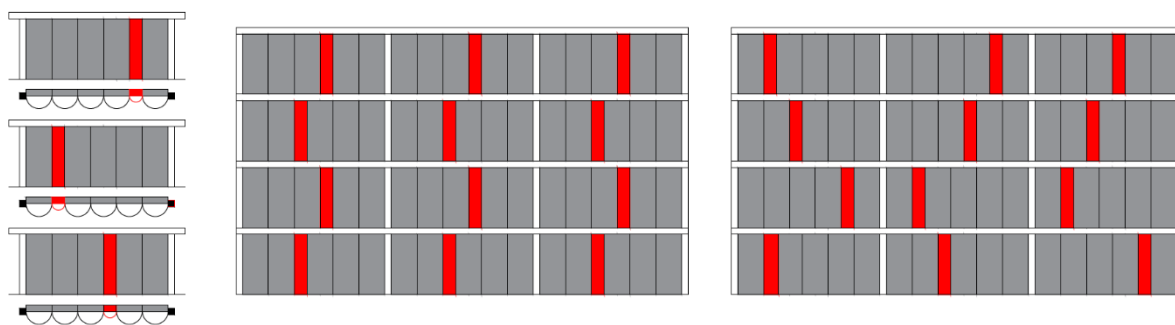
Diversi posizionamenti del modulo di 0.60 metri nel sistema di facciata Ac.Ca. Building.
